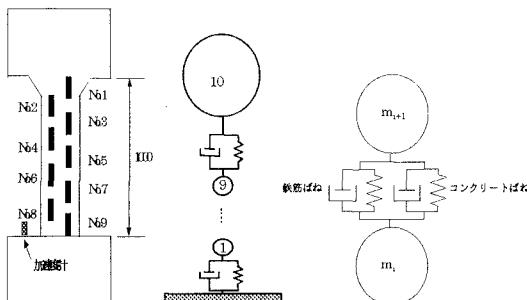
測定位置 図-4 解析モデル 図-5 質点間の連結
